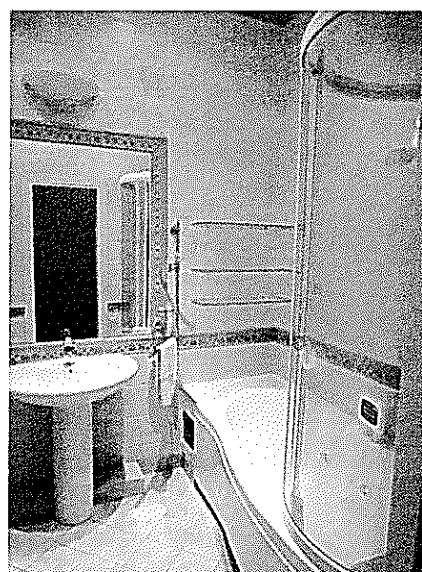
Совмещенный санузел (помещение 18 по плану)
